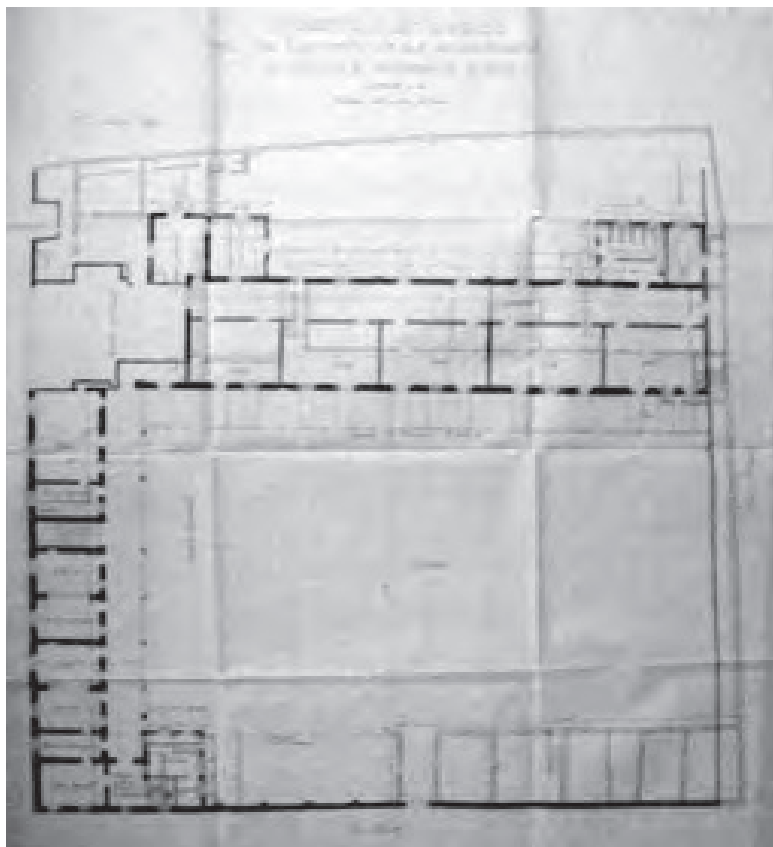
Regia Scuola Normale: progetto della pianta del piano terra (ASCF, b. 572, 1916)
